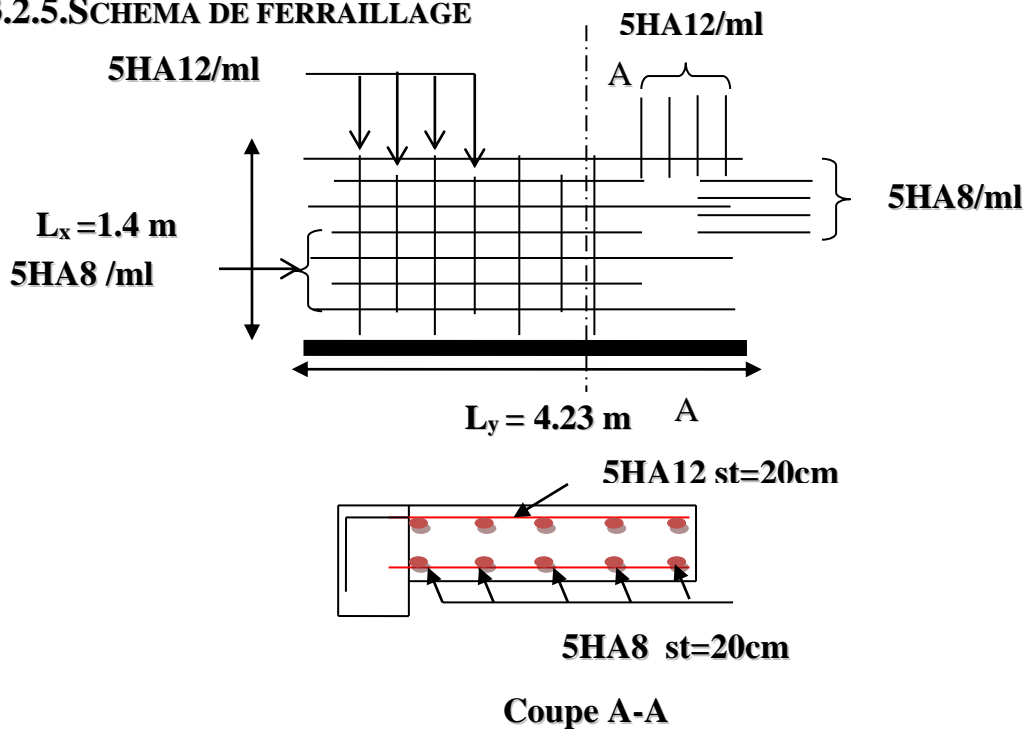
Schéma de ferrailage dalle pleine sur un seul appui.
